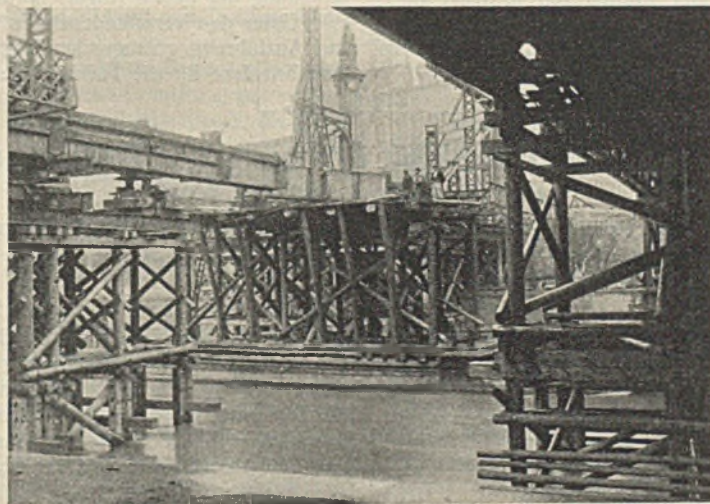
Ausschwimmen der mittleren Streckbalkentelle.
